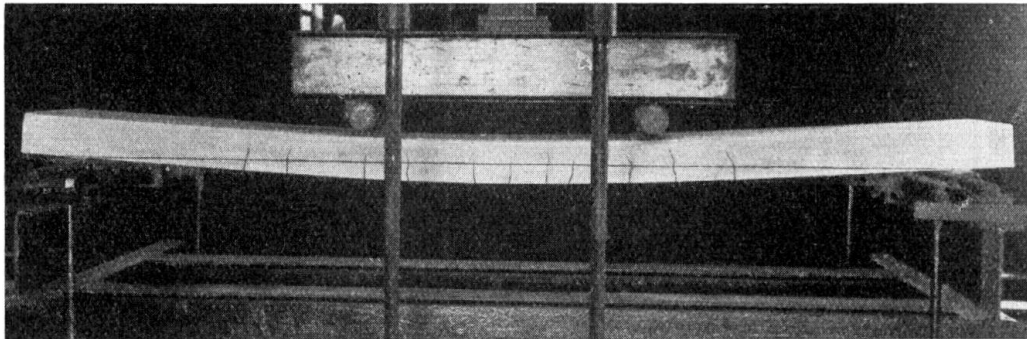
Platte mit Baustahlgewebe bewehrt (Dresdner Versuche 1934).
